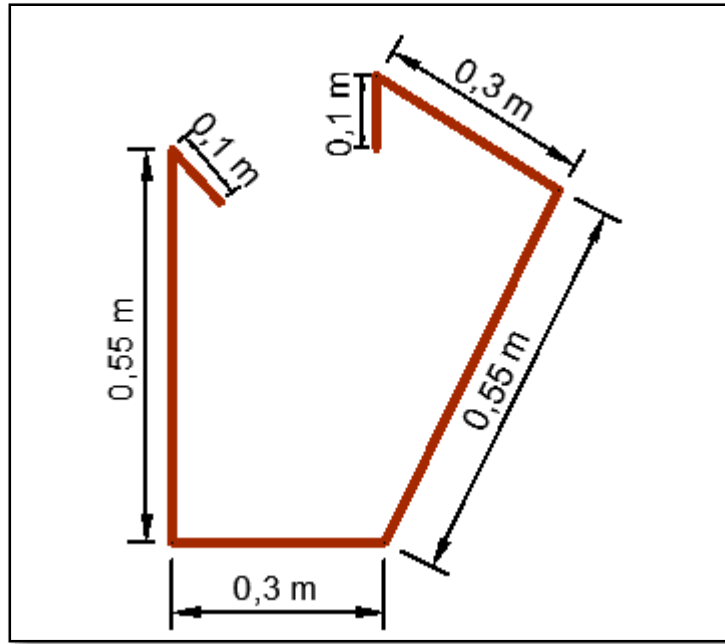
Detalle de estribo para la viga de apoyo. Fuente: Autor de la pasantía.
